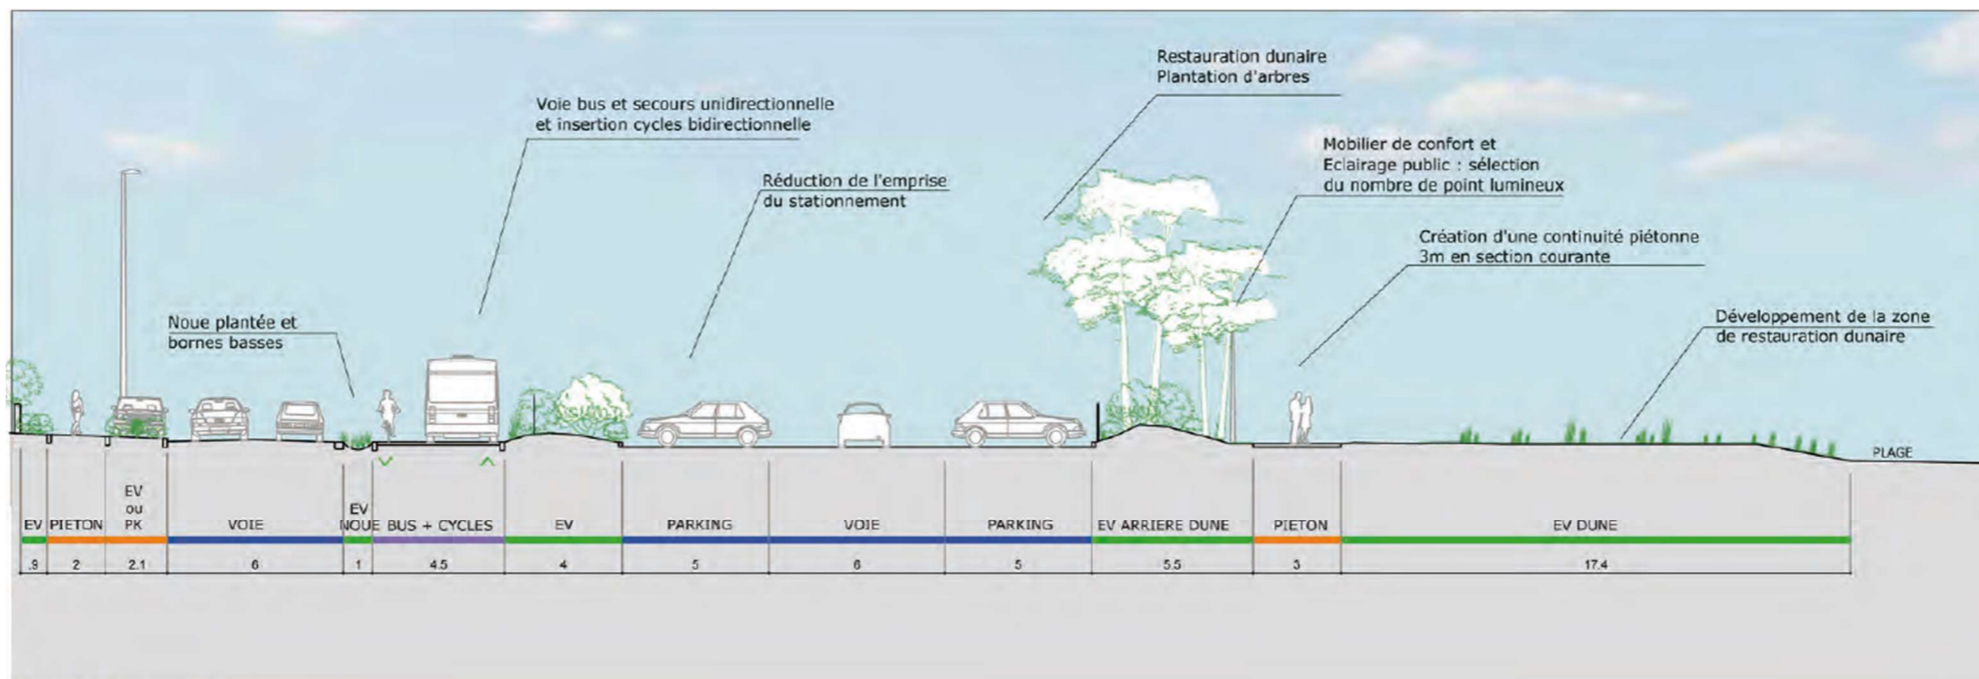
Coupe de principe avenue des dunes - stationnement du pas de la fontaine - du projet d'aménagement « 2. Aménagement du site propre et requalification de la plage sud de Rivedoux »
